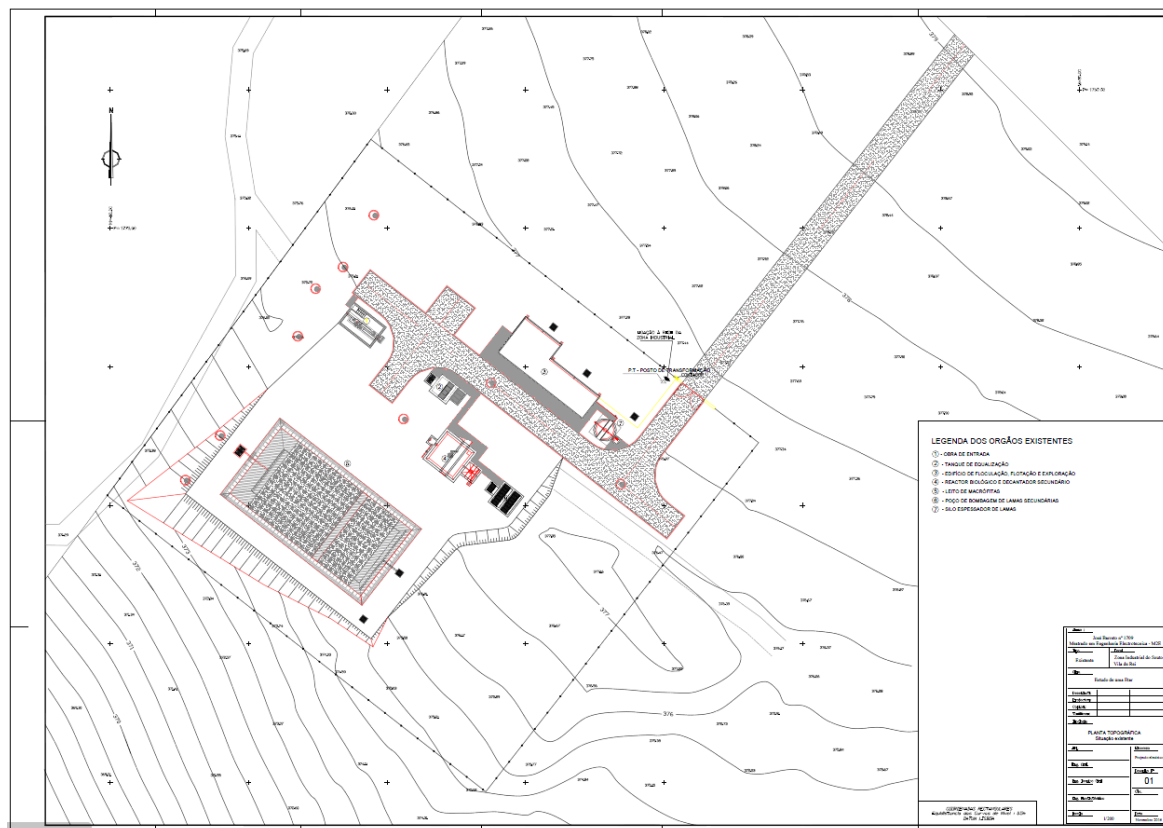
Planta de implantação dos órgãos existentes da ETAR
